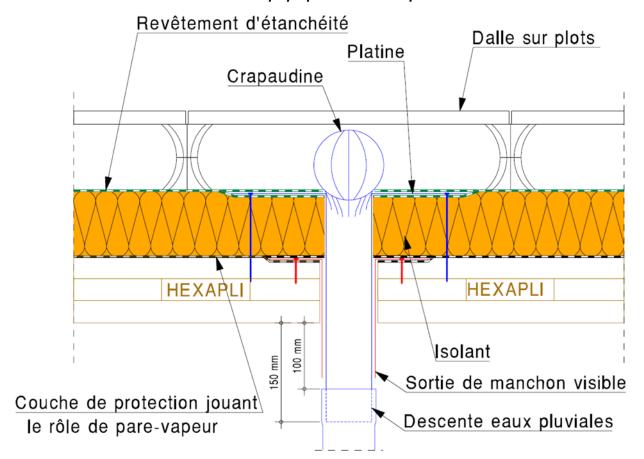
Toiture chaude isolée accessible - Entrée des eaux pluviales avec crapaudine Coupe perpendiculaire à la pente
